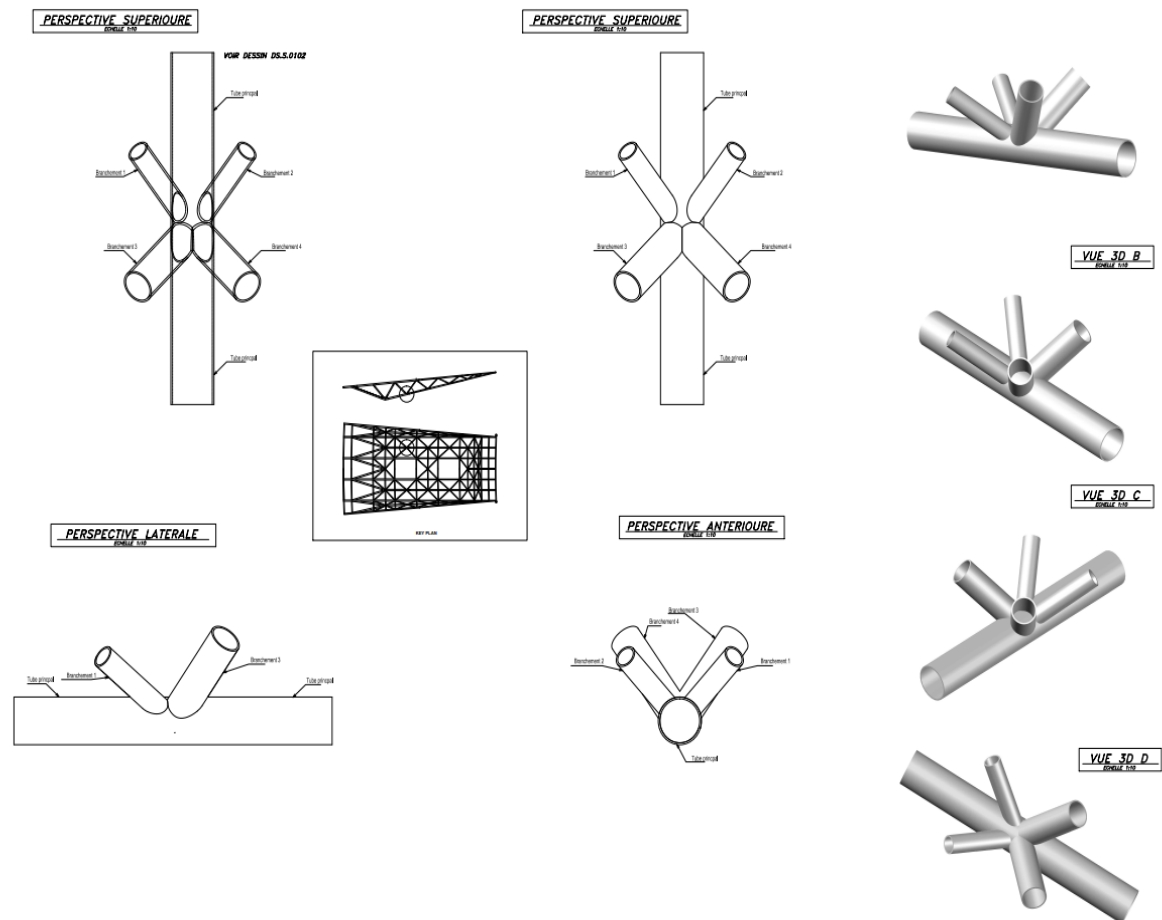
L'assemblage soudée type 3 de Nœud 3
